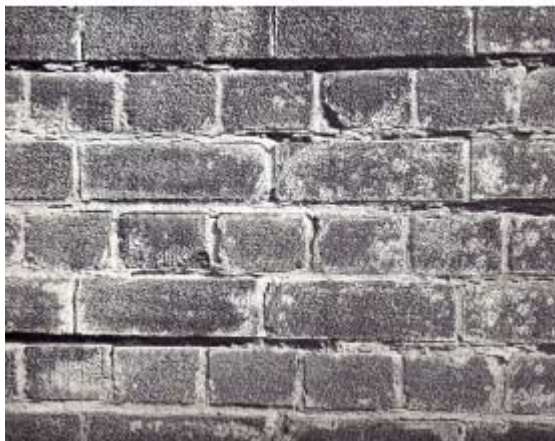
fissuras horizontais nas juntas de argamassa causadas por reações químicas (ELDRIDGE, 1982)
